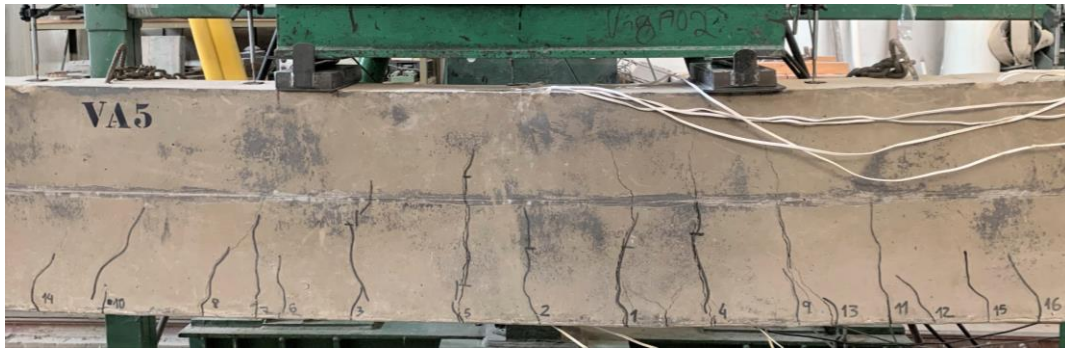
Vista frontal do trecho central da viga VA5 após o ensaio.
